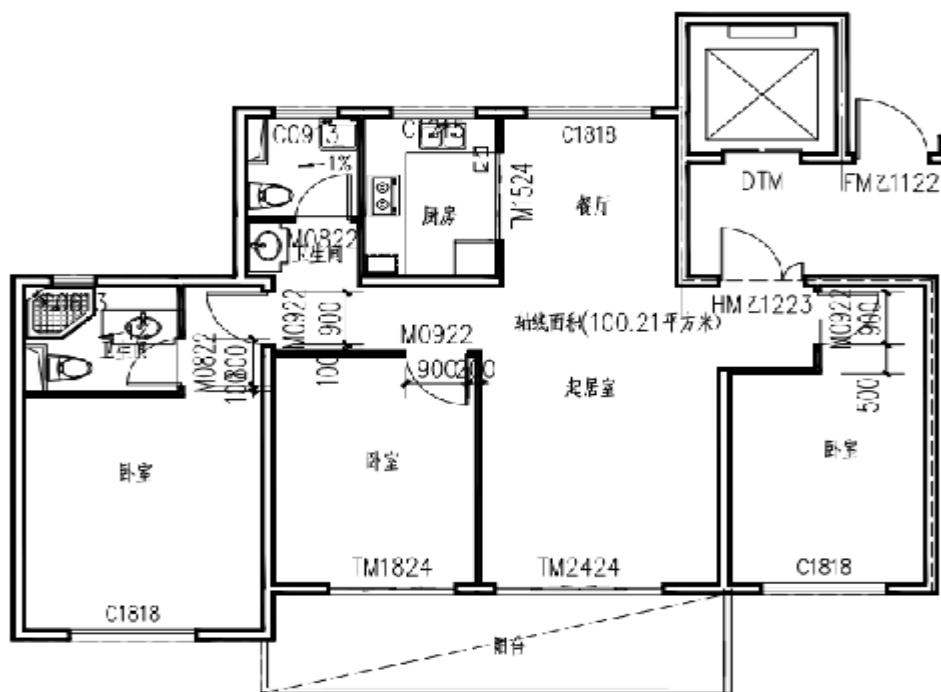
建筑平面示例 (建筑面积 101.3 m²)
